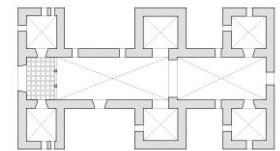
Planta Estructural de la Iglesia San Juan Bautista
